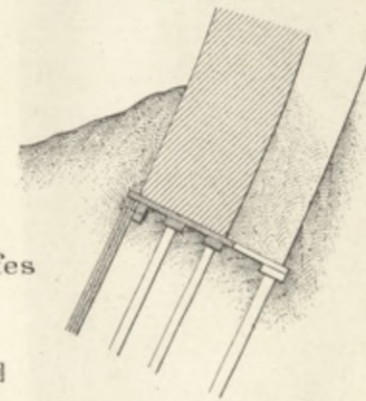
Widerlager der Donaubrücke bei Munderkingen. M. 1:200.
